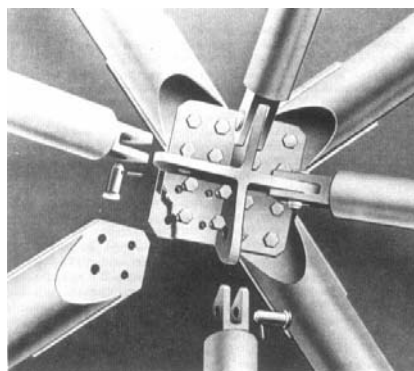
Sistema de ligação RAIJOINT – Holanda (Gerrits, 1984)
